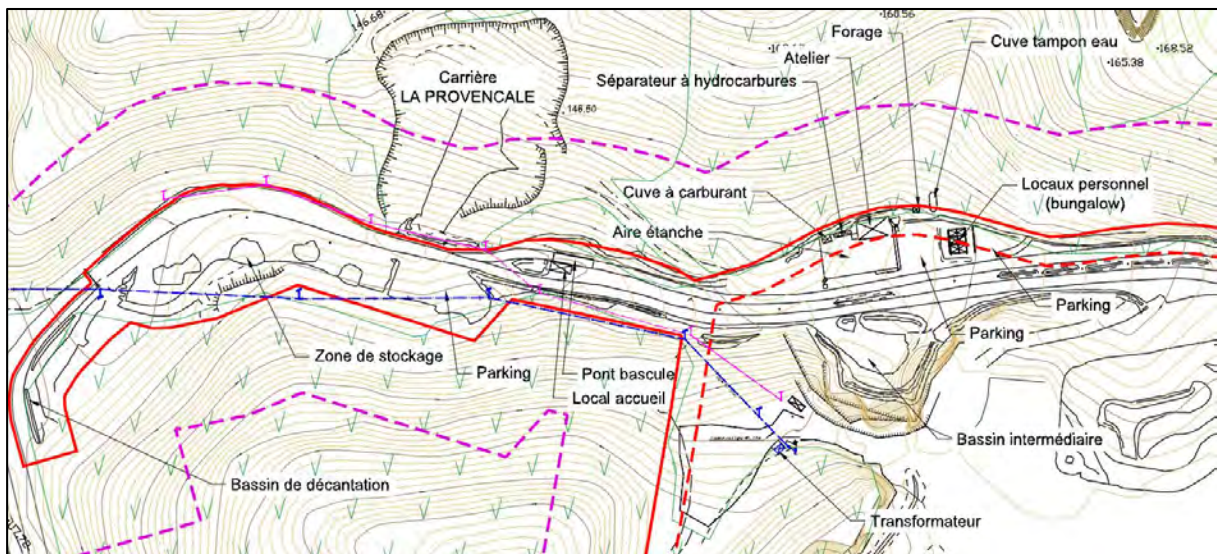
Plan de masse des installations annexes (entrée, accueil et base de vie)
